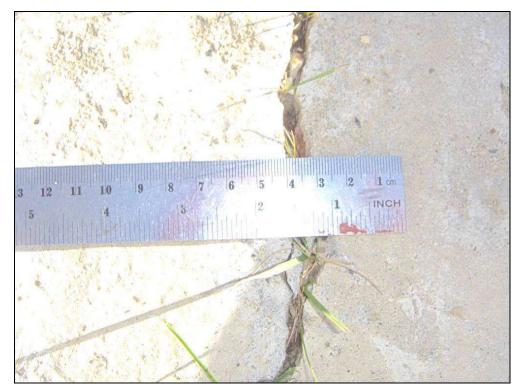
Крупнее см. ф. 90, ширина раскрытия до 8 мм
